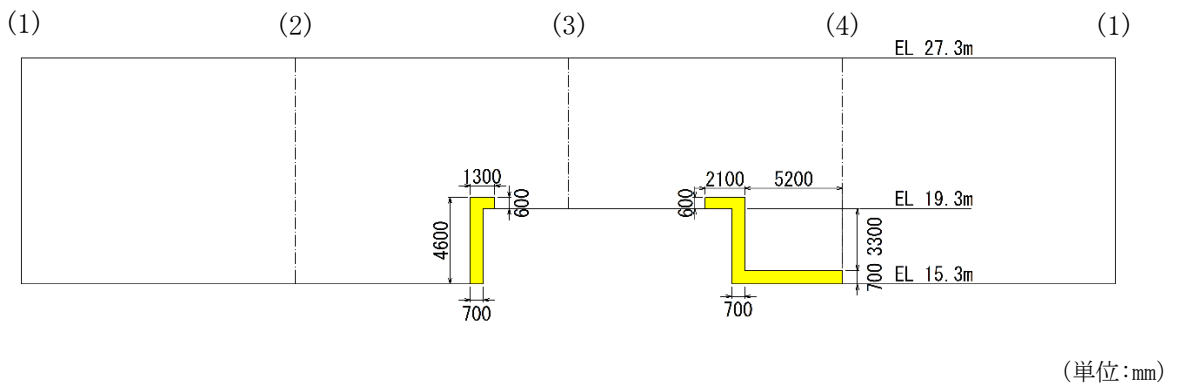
復水貯蔵タンク遮蔽壁 断面図 (A-A 断面, 東西)
